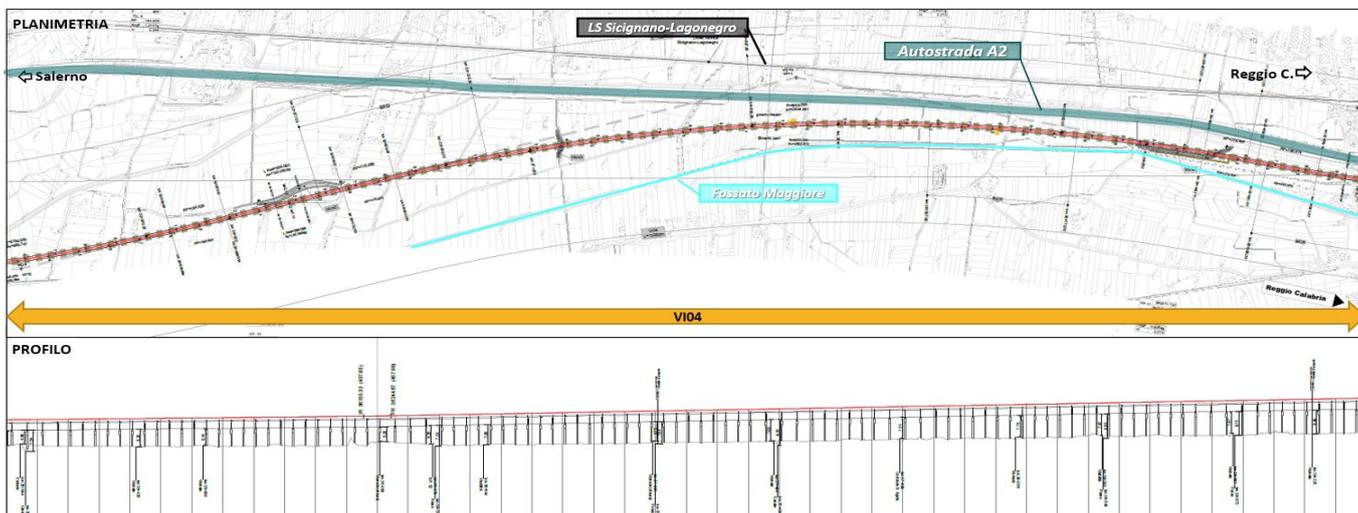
Planopprofilo di progetto da km 35+100 a km 39+300
